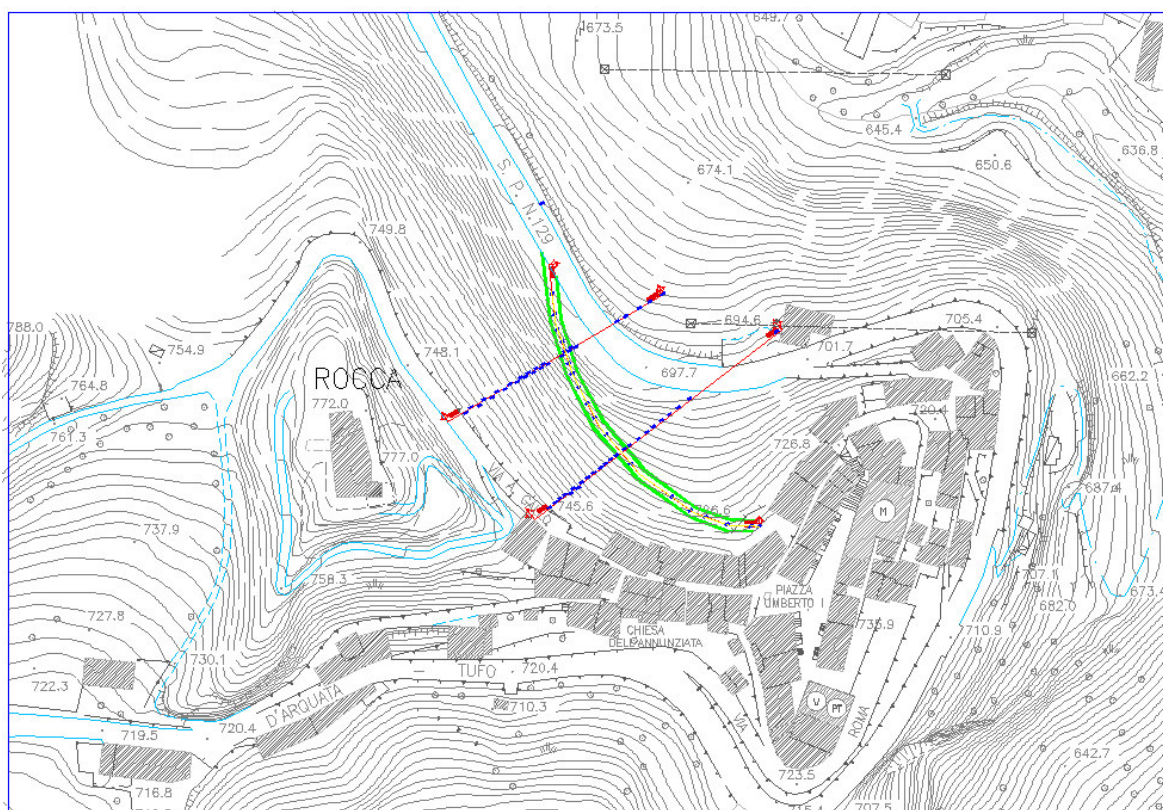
Individuazione planimetrica della rampa temporanea di accesso
